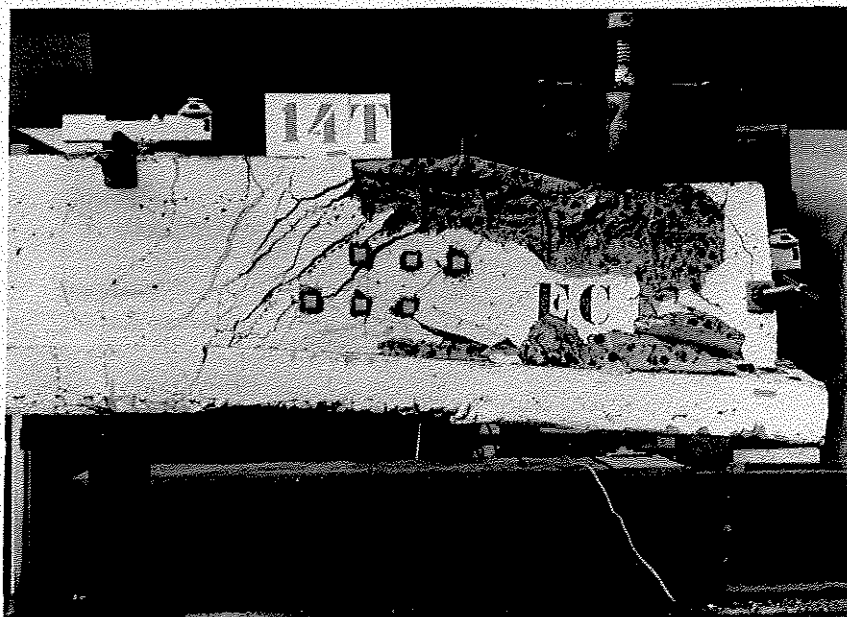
Detalhe evidenciando rutura de biela da viga V25B*.
